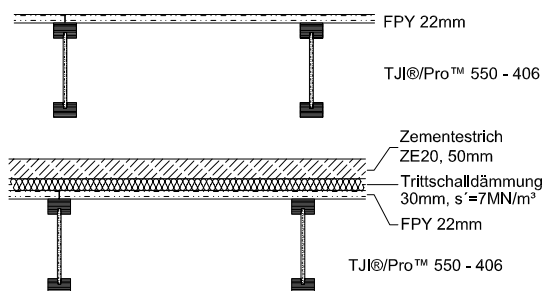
Holzdeckenaufbauten auf Basis eines Holzstegträgersystems; oben: Rohdecke, unten: Decke mit Estrichaufbau
